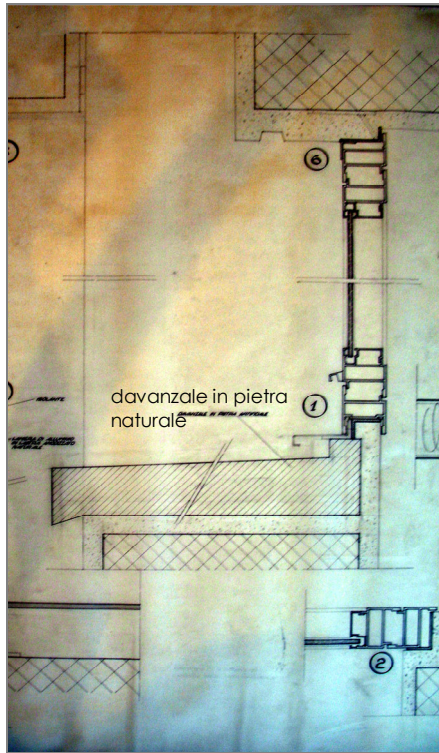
particolare serramento (fonte CSAC – stralcio tav. 31, archivio n. 400-1, rielaborazione f.m.)
